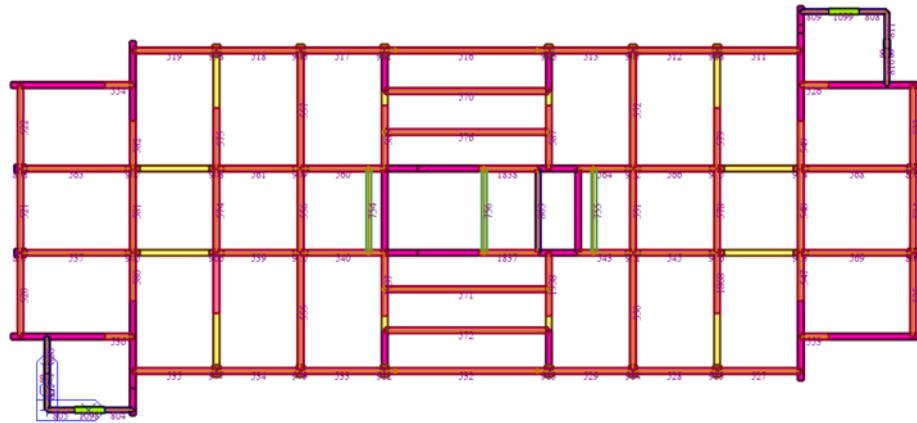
Statik analiz modelinde yapının bodrum kat tavan kalıp planı
